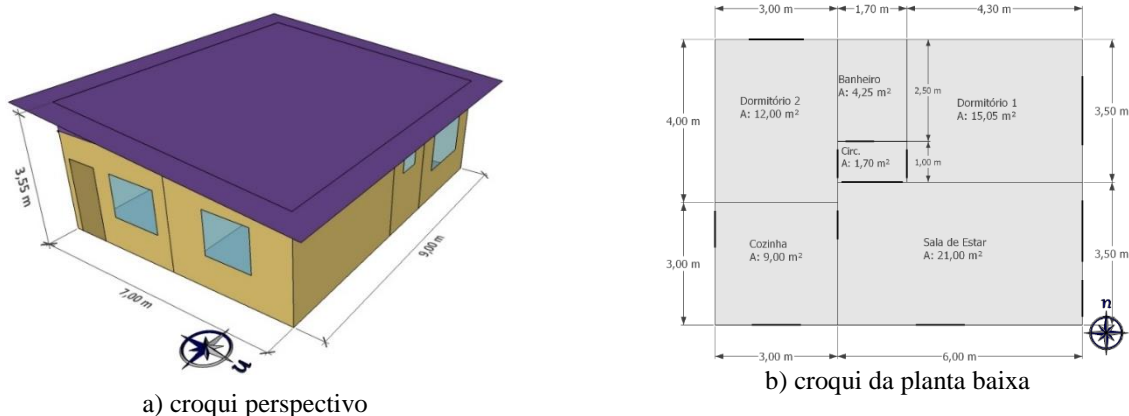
Croqui perspectivo e croqui da planta baixa do modelo residencial
